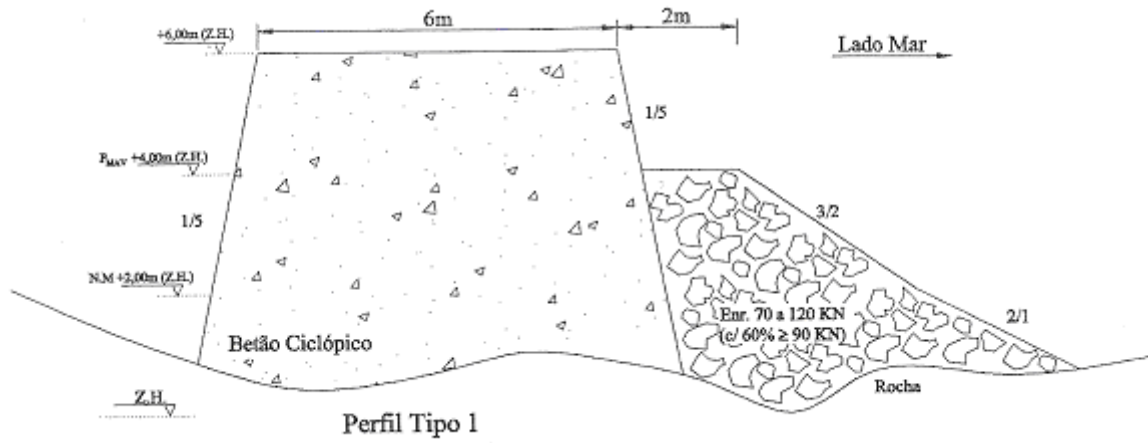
Perfil transversal tipo 1, do quebramar destacado da praia da Aguda (IHRH).
